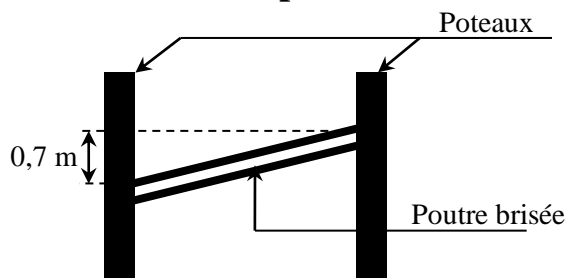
Vue en élévation de la poutre brisée Figure III.14. Schéma statique de la poutre brisée
